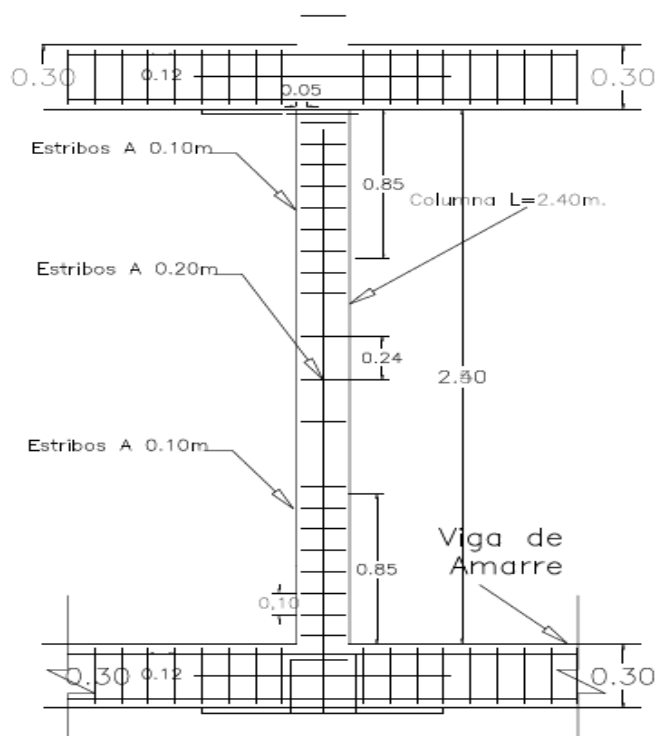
Detalle distribución de refuerzos en la columna. (Fuente: Elaboración propia)
